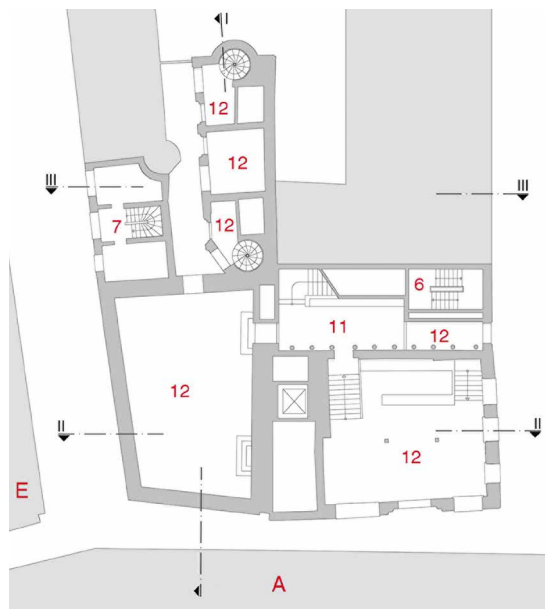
Figurentheater; Grundriss Zwischengeschoss [© Konermann Sigmund Architekten BDA Stadtplaner]
